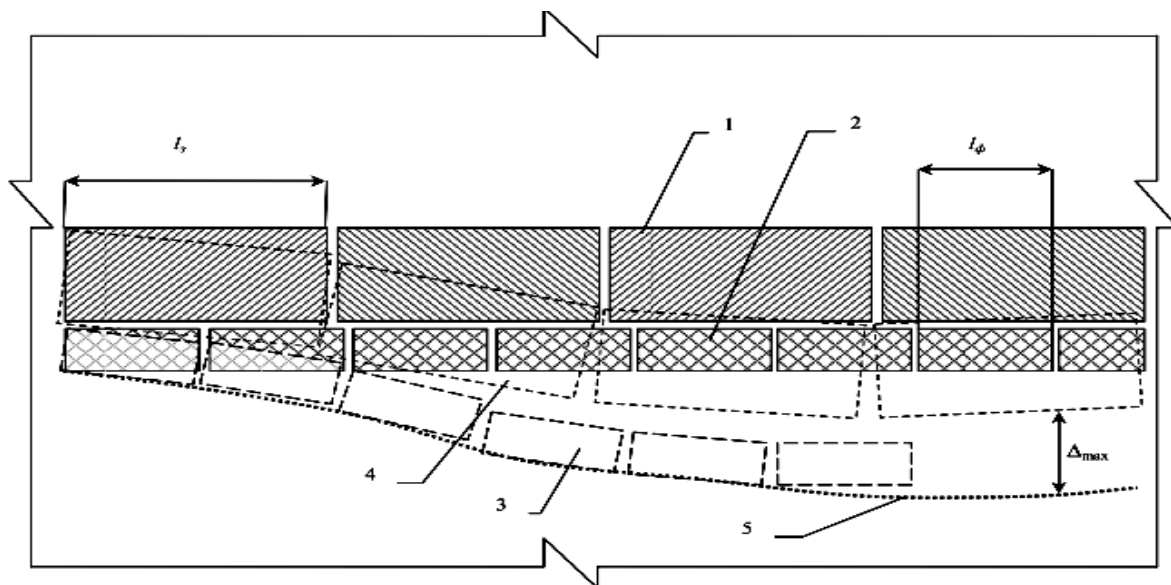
Розрахункова схема деформації водопропускної труби внаслідок переміщення (зрушення) основи: 1 – проектне положення ланки труби; 2 – проектне положення блоку фундаменту; 3 – положення блоку фундаменту після переміщення; 4 – положення ланки труби після переміщення; 5 – очікувана лінія опису переміщення основи;  $l_z$  – довжина ланки труби;  $l_\phi$  – довжина блоку фундаменту;  $\Delta_{max}$  – максимальне значення вертикального переміщення на ділянці.
